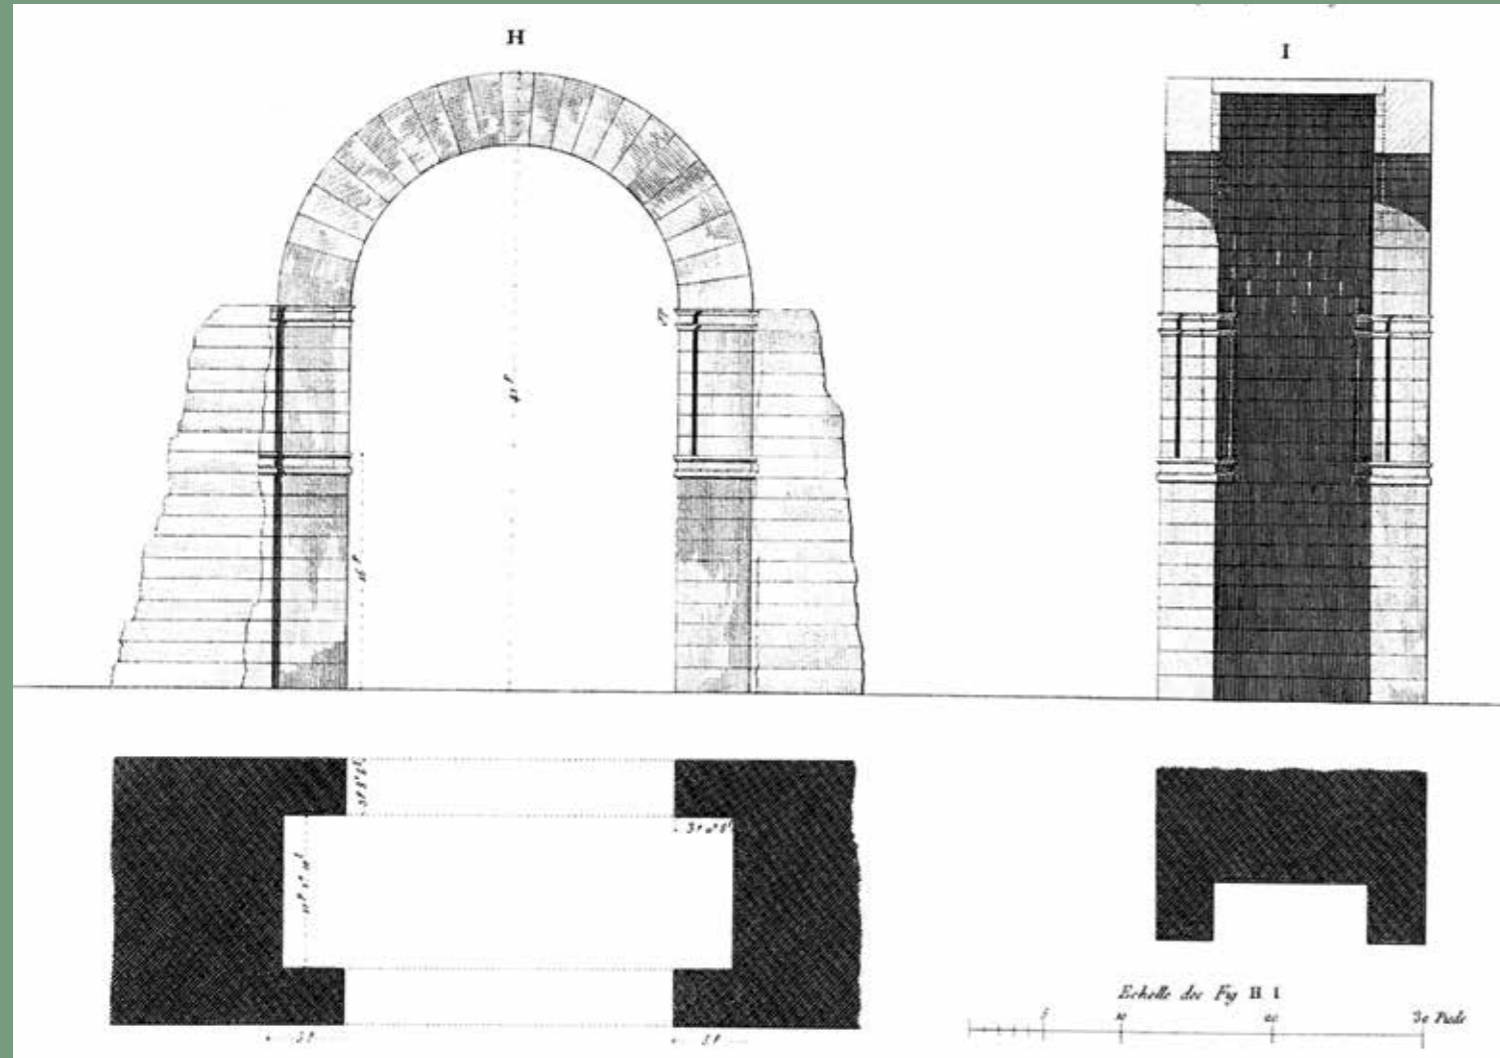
Planos y levantamientos arquitectónicos de una de las fachadas y de uno de los vanos laterales del "Arco de Trajano", publicados por A. De Laborde
